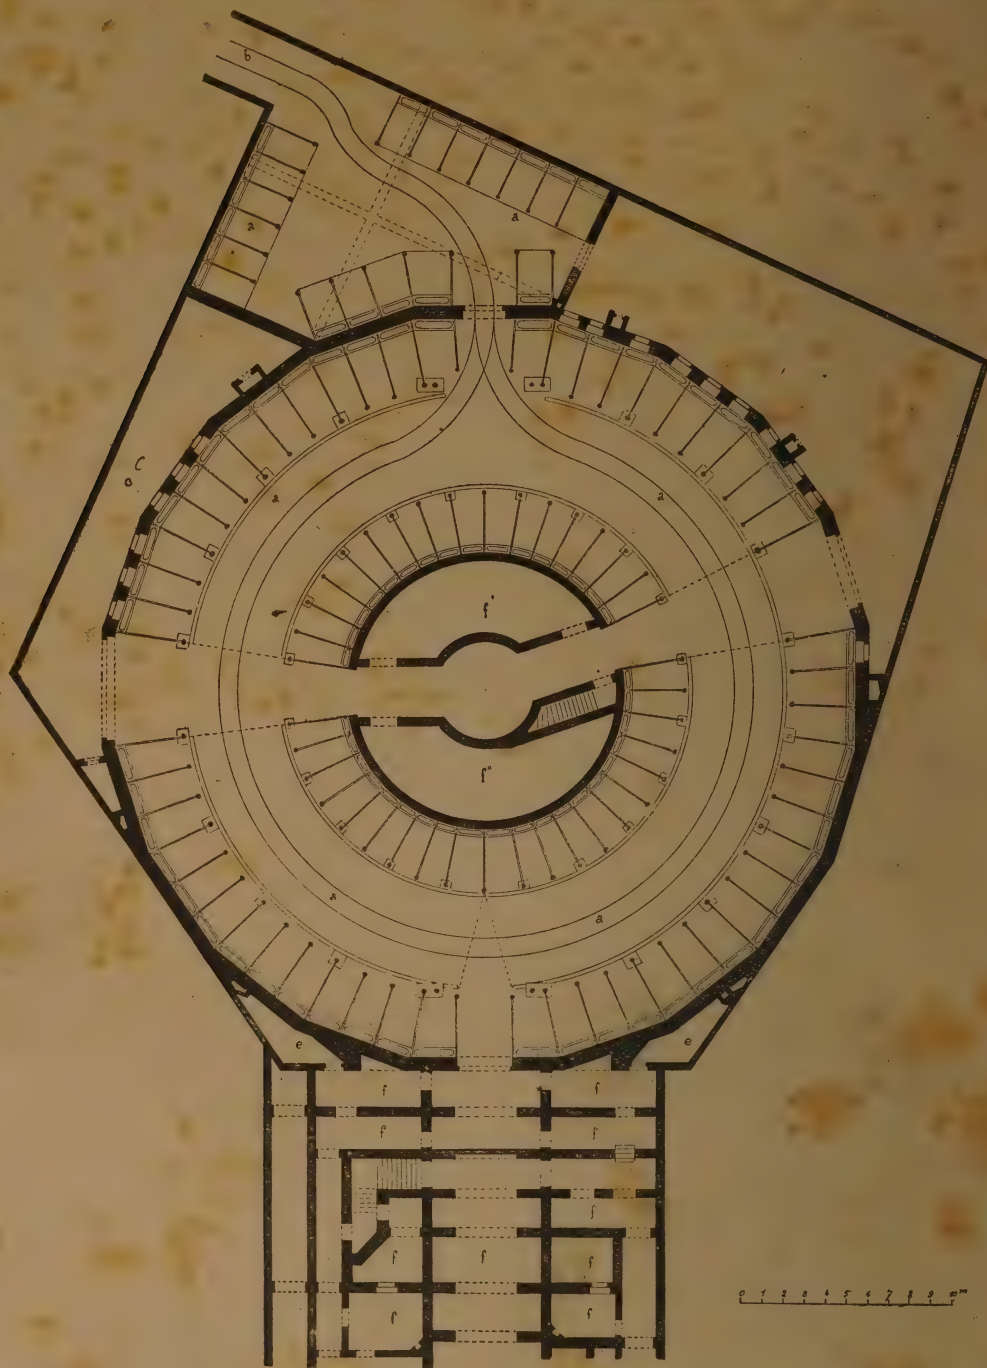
Plan du Cirque royal à Bruxelles. — Rez-de-chaussée.
